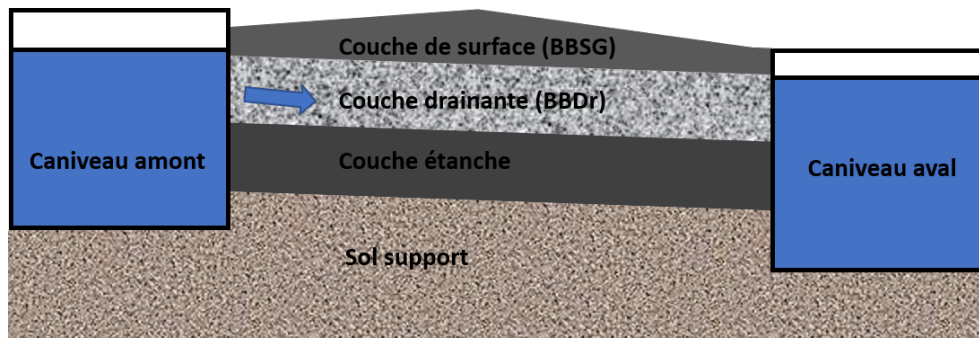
Schéma descriptif de la structure de la chaussée installée (vue de face)
